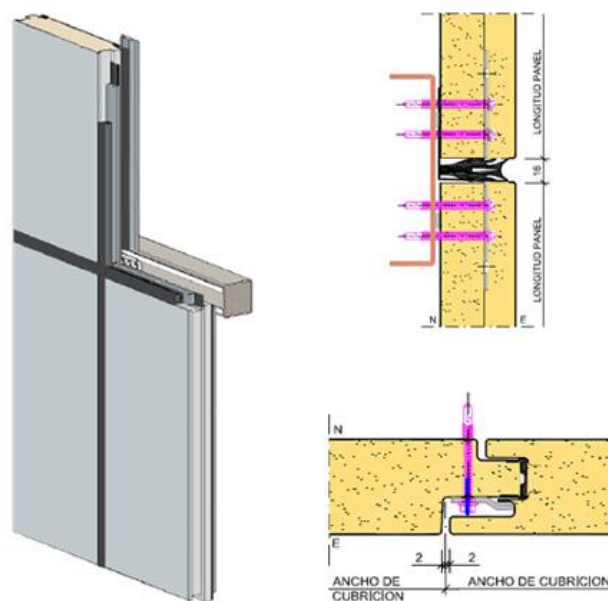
Detalle panel aislante. Fuente: tecnopanel.cl
